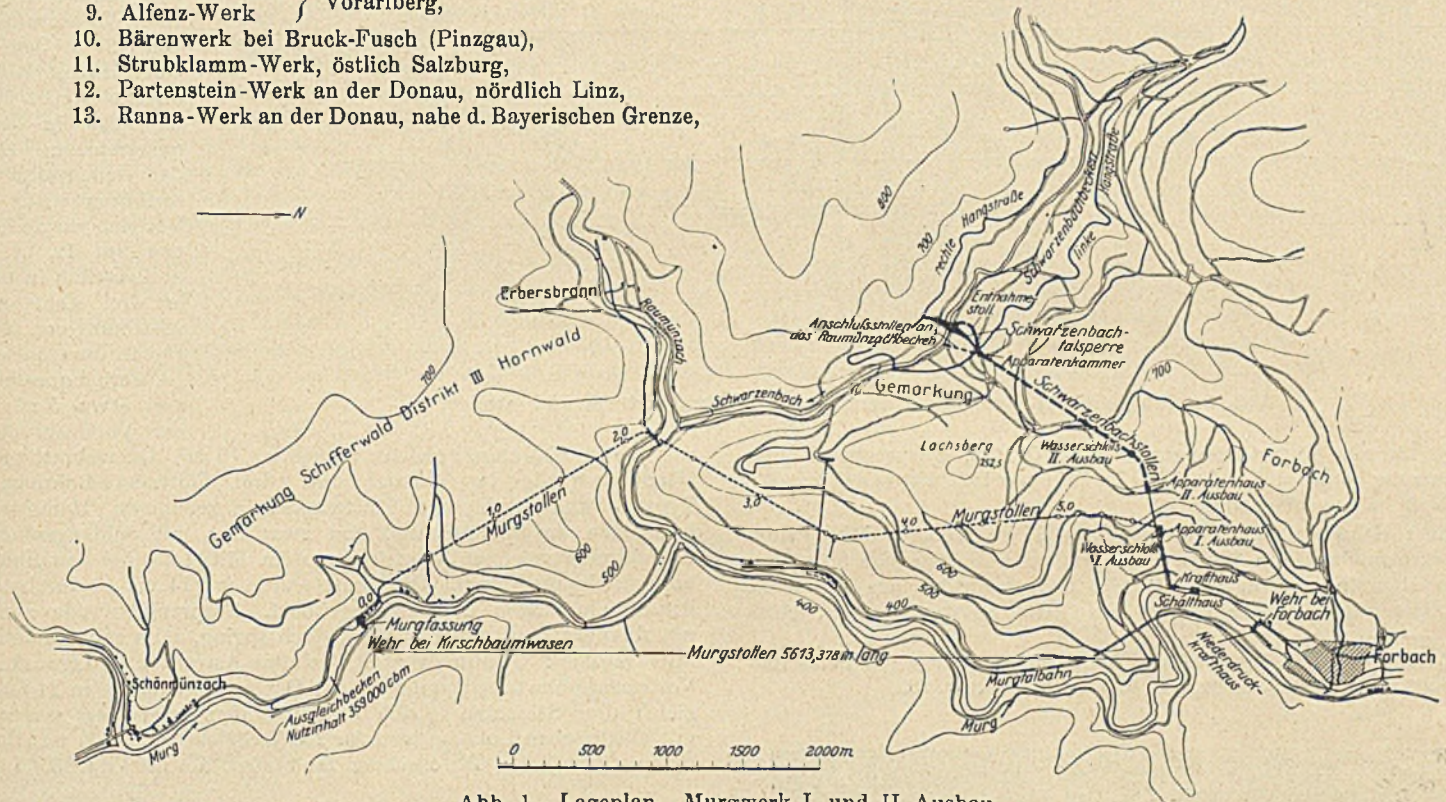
Lageplan. Murgwerk I. und II. Ausbau.
